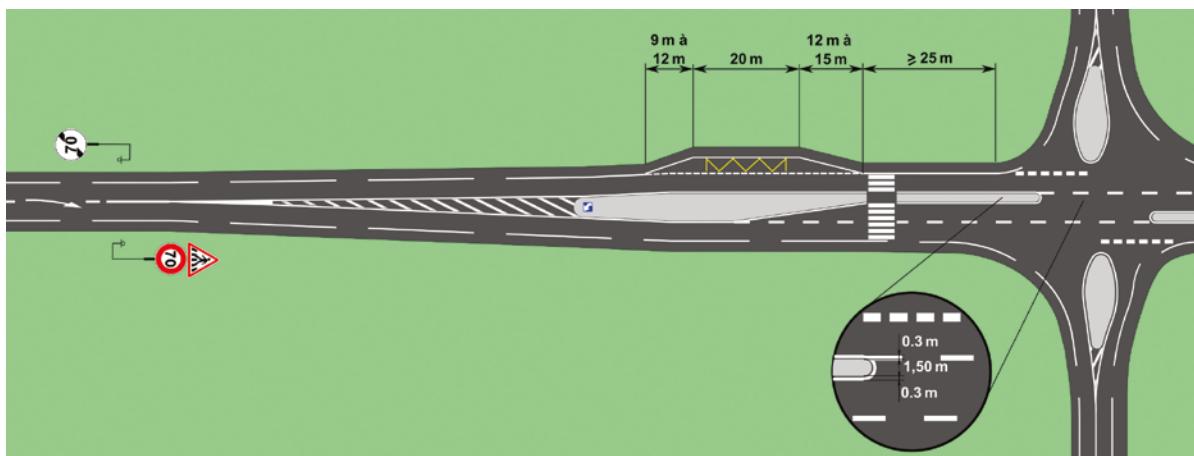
Arrêt bus au niveau d'un carrefour plan ordinaire
